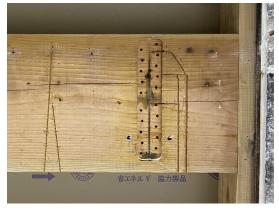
試験体 2-2 耐火構造壁内の梁(ベイマツ製材)表面
